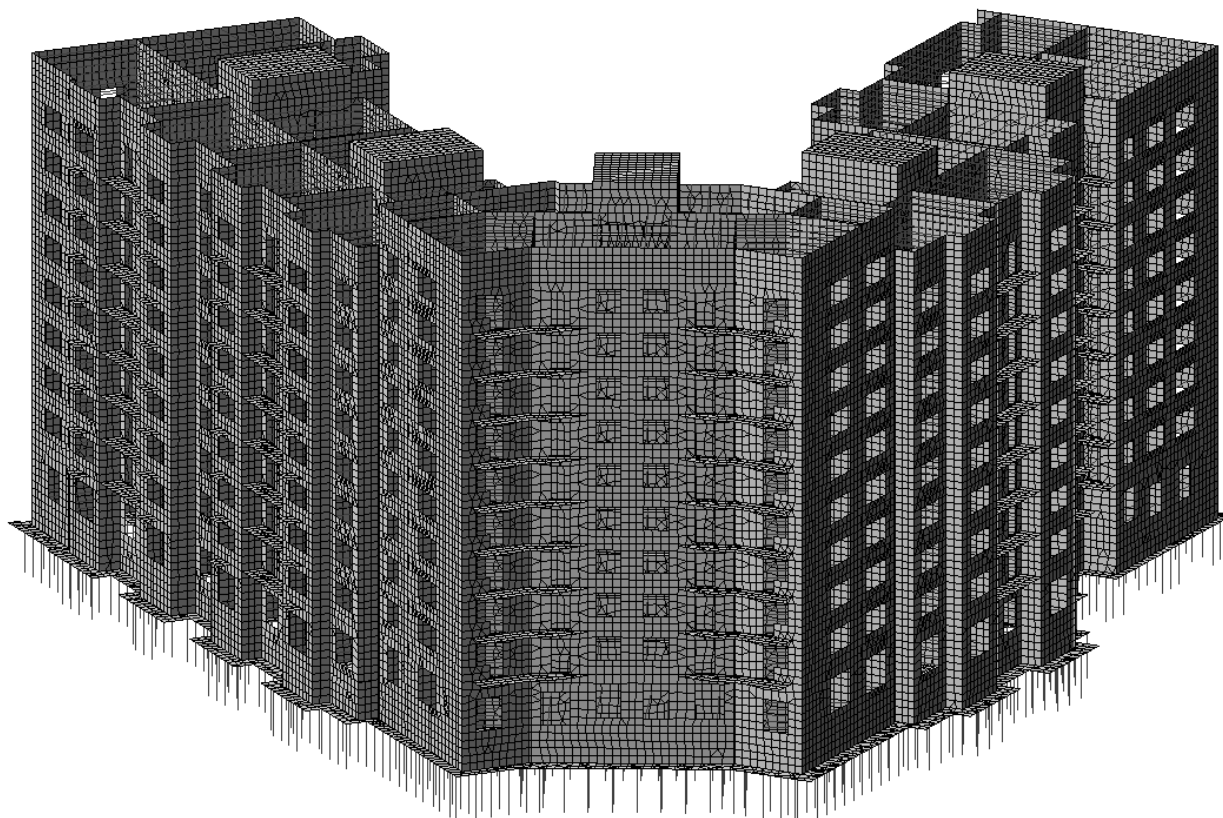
Розрахункова схема системи «будівля – стрічковий фундамент – слабка основа, підсилена грунтоцементними елементами армування»
